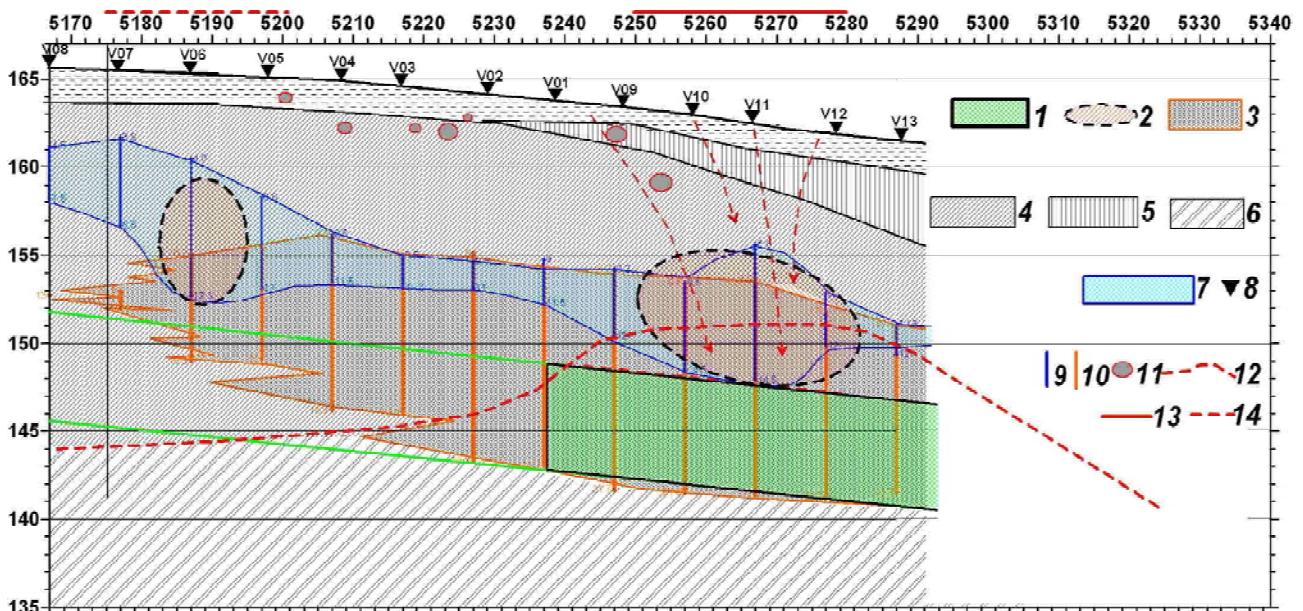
Геолого-геофизический разрез участка строительства туннелей метро на перегоне между станциями "Голосеевская" – "Васильковская" (ПК 51+67 – ПК 53+40) по геофизическим данным ВЭРЗ: 1 – зона подземной выработки на 15.07.08; 2 – провалоопасные участки (ослабленные зоны); 3 – песок; 4 – суглинки, супеси; 5 – суглиники лессовидные; 6 – песок, насыщенный водой; 7 – водонасыщенная зона фильтрационно-миграционного водного потока; 8 – пункты ВЭРЗ; 9 – глубина залегания увлажненного грунта по данным ВЭРЗ; 10 – глубина залегания песчаных отложений; 11 – подземные коммуникации; 12 – кровля песчаного горизонта по геологическим данным; 13 – ПК 52+50 – 52+80, 14 – ПК 51+75 – 52+00
